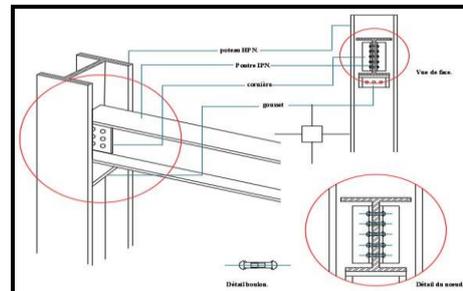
Détail n°03: Assemblage boulonné d'une poutre à l'âme d'un poteau (1/20)
